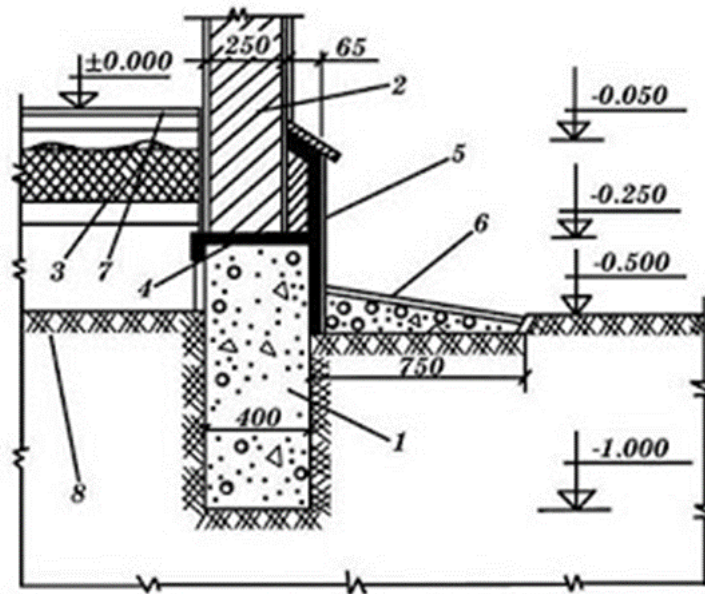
Конструктивний вузол стрічкового фундаменту з монолітного бетону: 1- фундамент з монолітного бетону марки 100 (ширина – 40 см, висота – 75 см, глибина заложення в ґрунт основи – 50 см); 2 – стіна; 3 – утеплювач; 4 – гідроізоляція; 5 – цоколь; 6 – відмостка; 7 – покриття підлоги; 8 – ґрунт.
